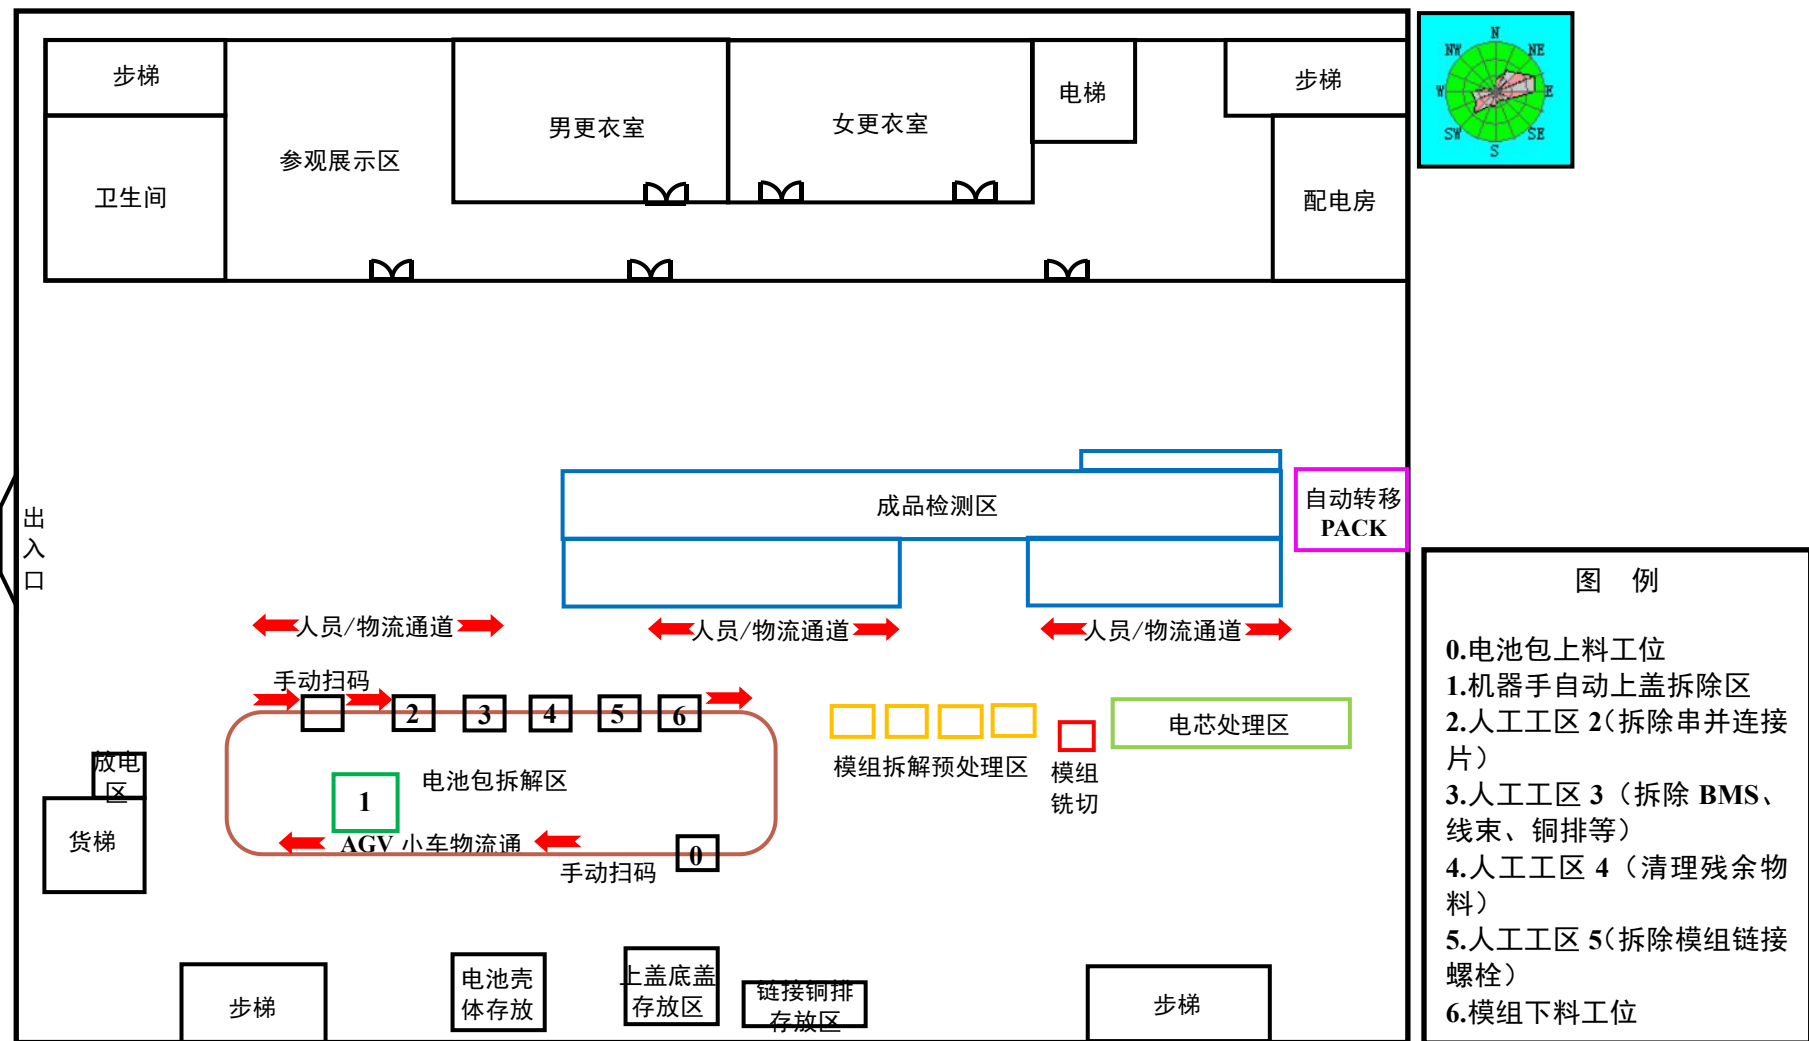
(2) 本项目生产区 (一层) 平面布置图
